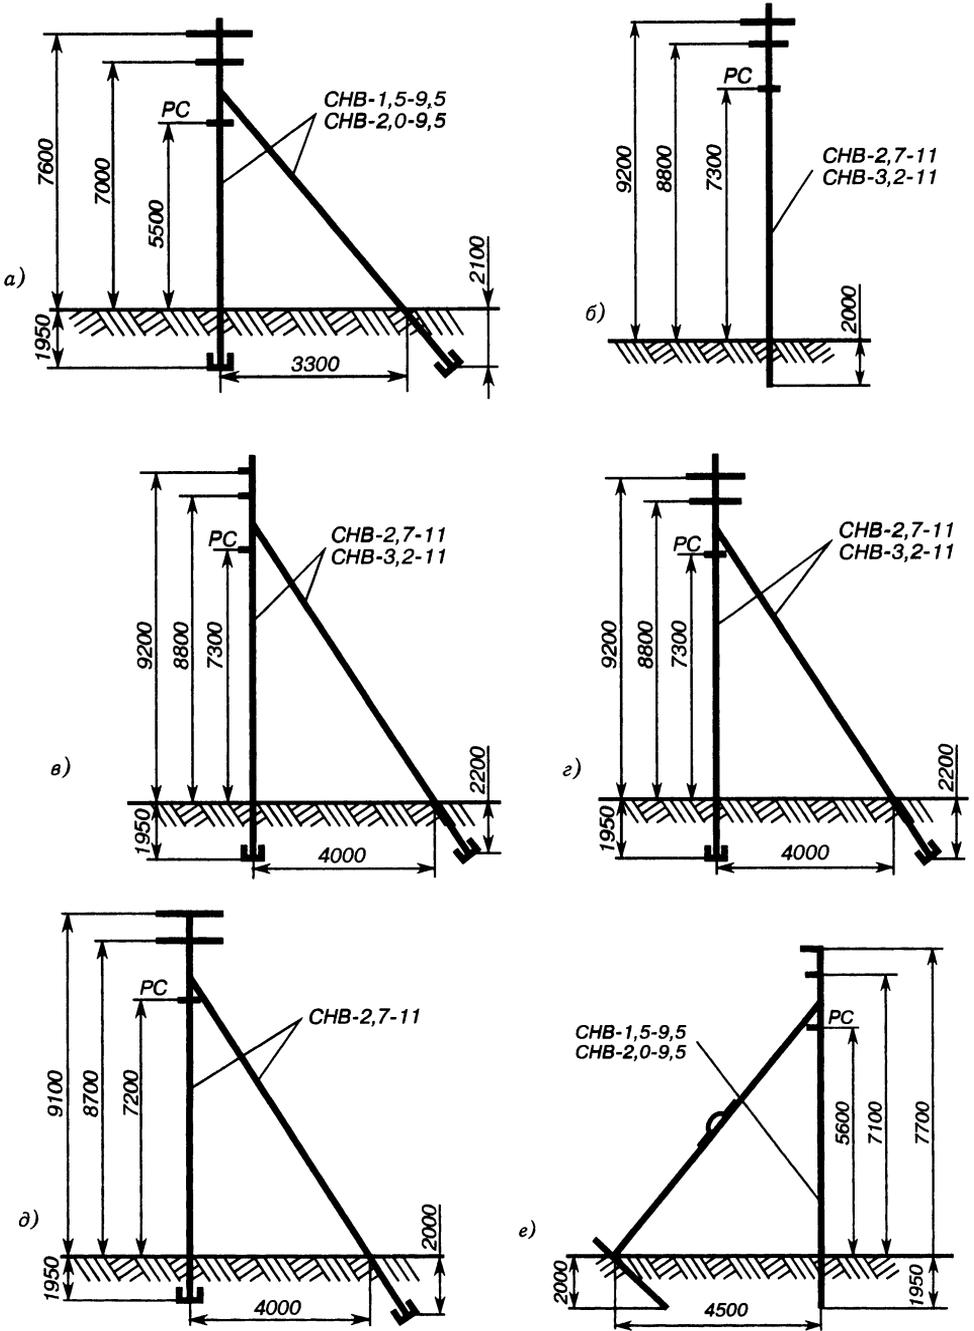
Схемы железобетонных опор ВЛ 0,4 кВ по типовому проекту 3.407–122.
